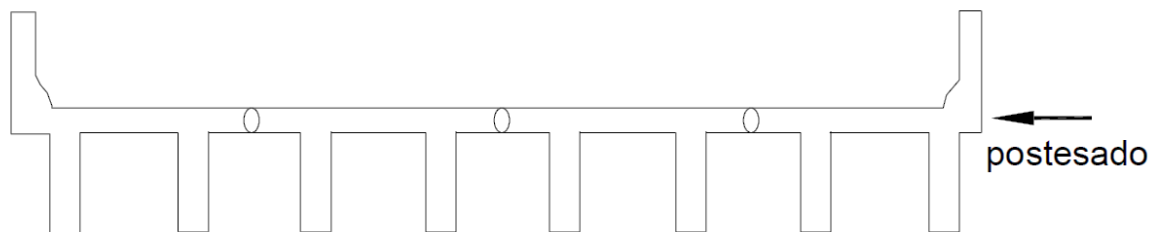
Sección transversal de puente con vigas doble Te con conectores de corte (AASHTO, 2007).
